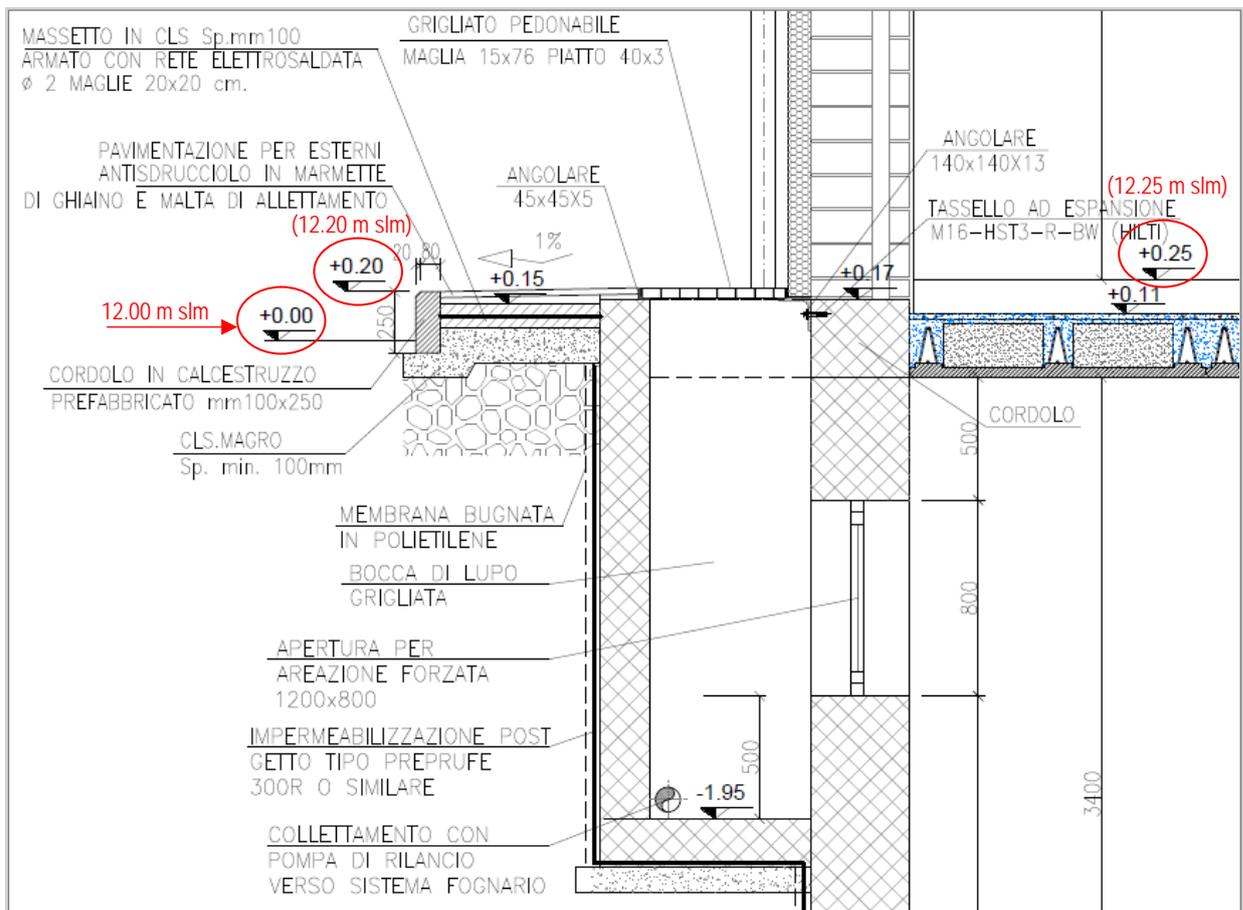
Cabinato ELCO EC8 – Particolare di sezione piano terra (Rif. [8])
